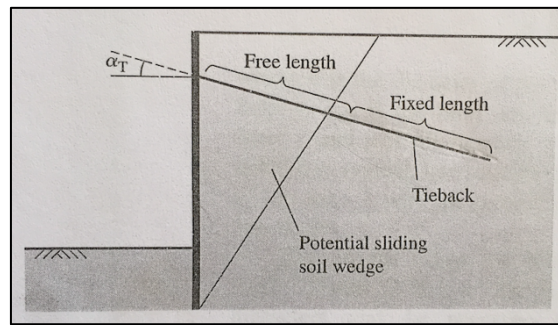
Longitudes de anclaje. (Fuente: Salgado R. *The Engineering of foundations. Cap. 16 Retaining Structures.*)
